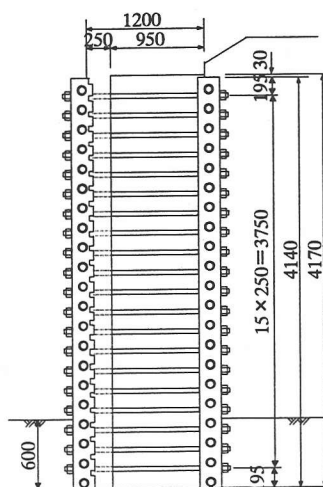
補強鋼材配置図 図-19 B高架橋施工工-
